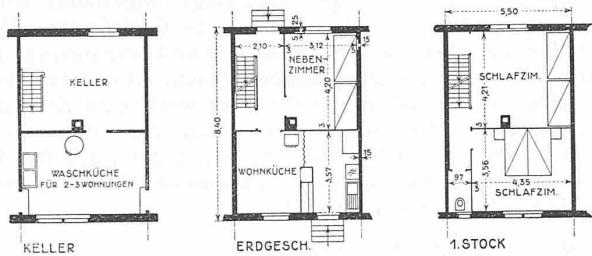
Grundrisse der Reihen-Einfamilienhäuser, 1 : 300.
